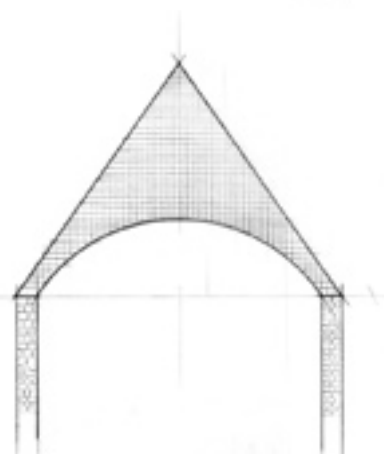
Entwurfsraum für Dachkonstruktion mit gewölbter Dachkonstruktion.
